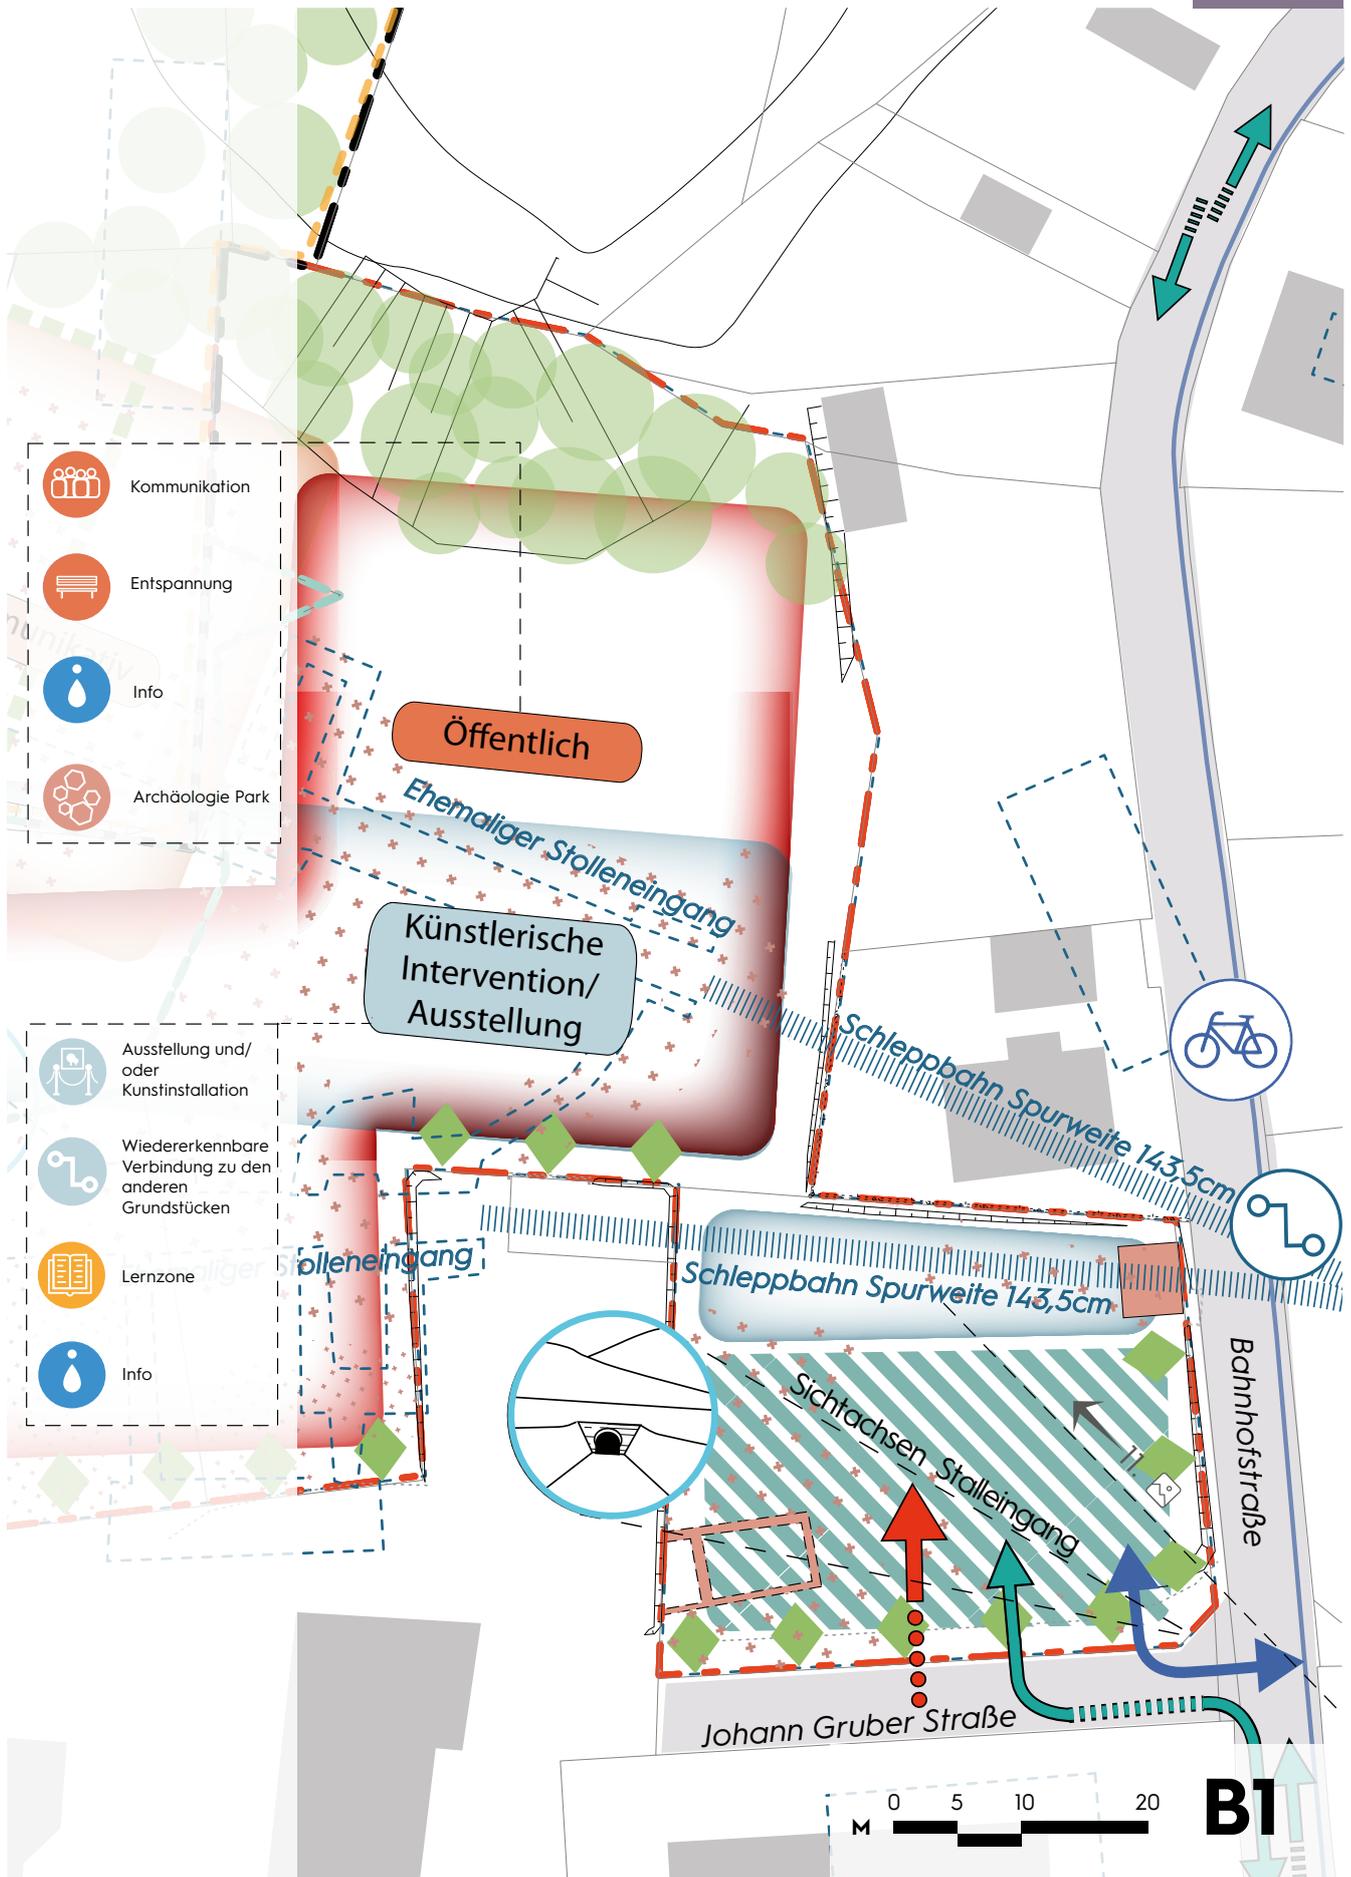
Masterplan Grundriss „Bergkristall“ (Ausschnitt B1)
